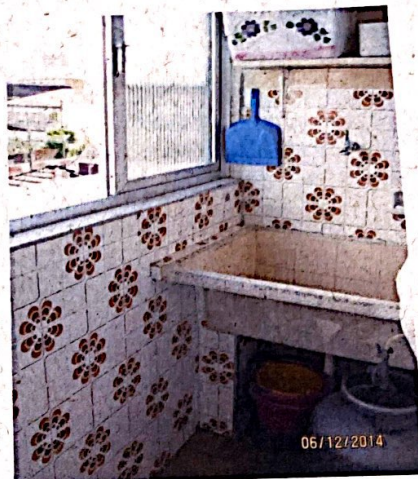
Vista do banheiro com acabamento em piso cerâmico, paredes revestidas com azulejos até o teto, laje de teto pintada com tinta látex, janela de alumínio, porta de madeira e louças de padrão comercial.
